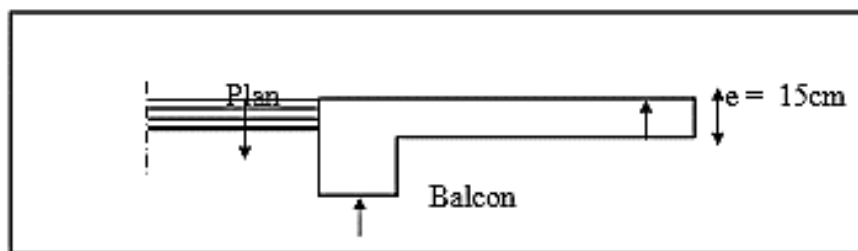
coupe verticale détaillant la liaison balcon- poutre de rive.
